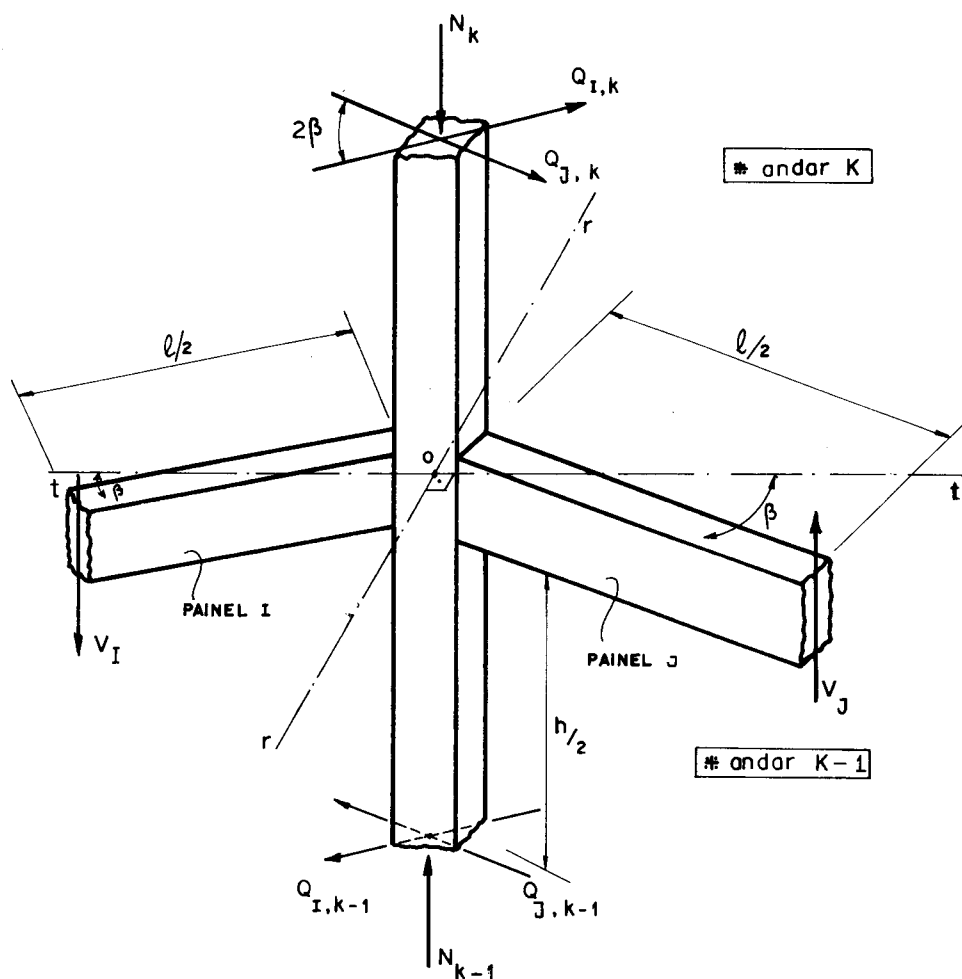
ESFORÇOS NAS VIGAS E PILARES .
